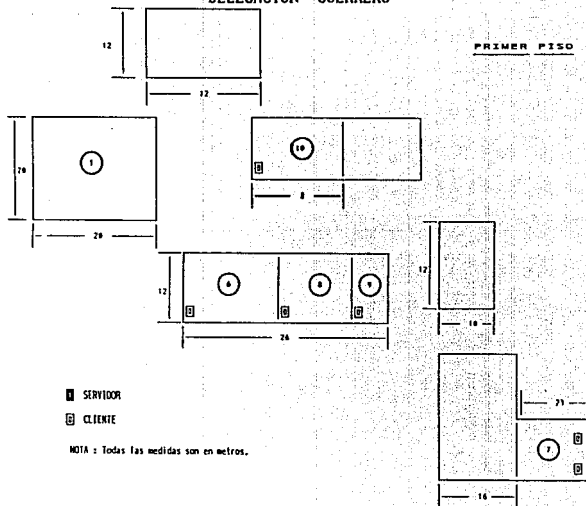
Planos de la Delegación en Guerrero, Primer Piso.
